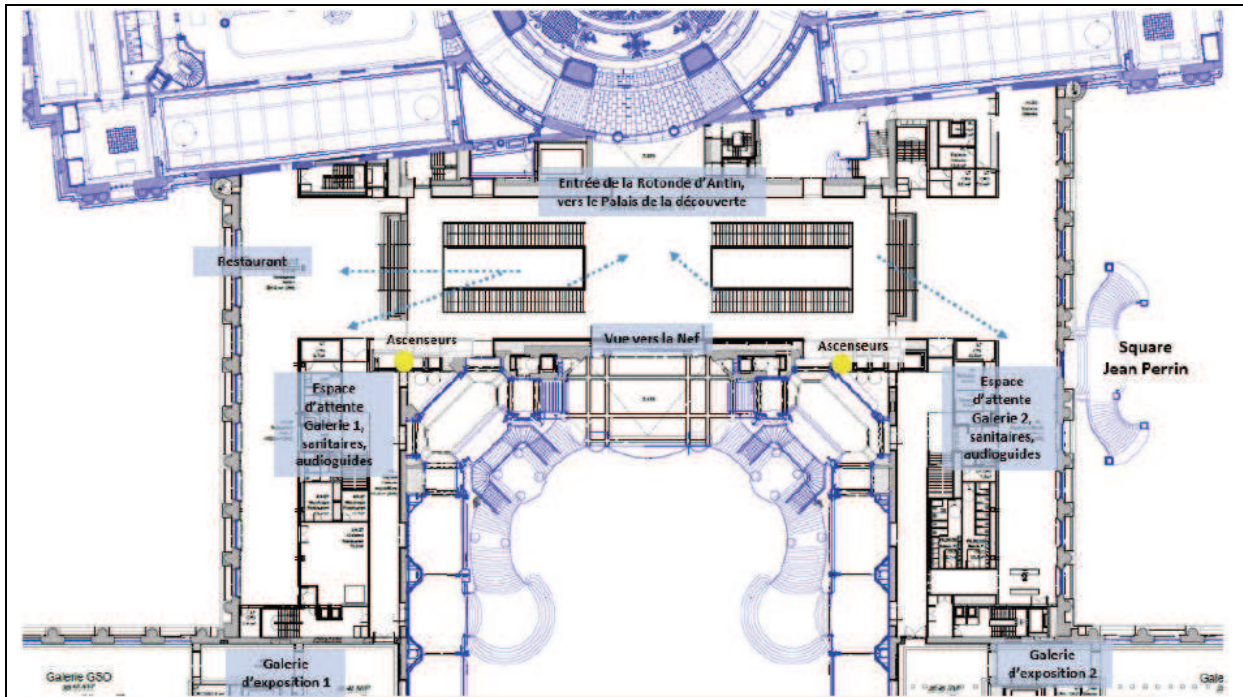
La Rue des Palais haute niveau rez-de-chaussée, accès et services aux visiteurs
